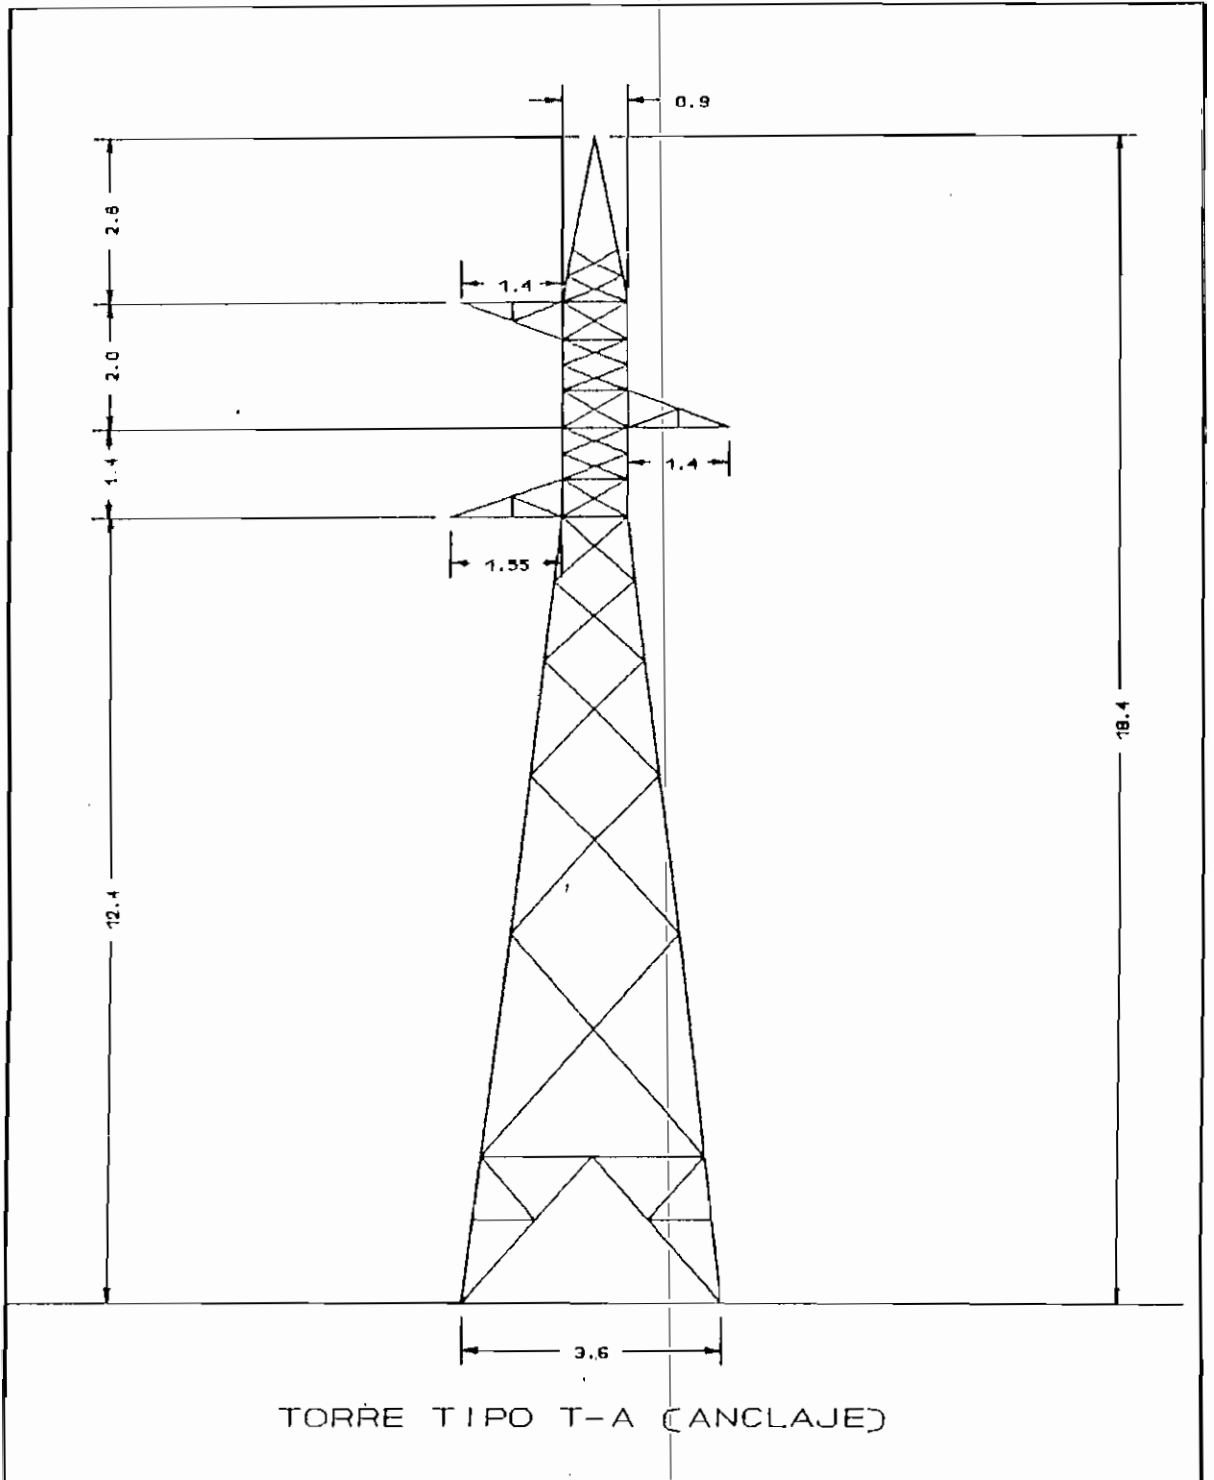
Alternativa L/T Ambato-Latacunga 138 KV, con diseño de aislamiento tipo retenida para las estructuras de suspensión
